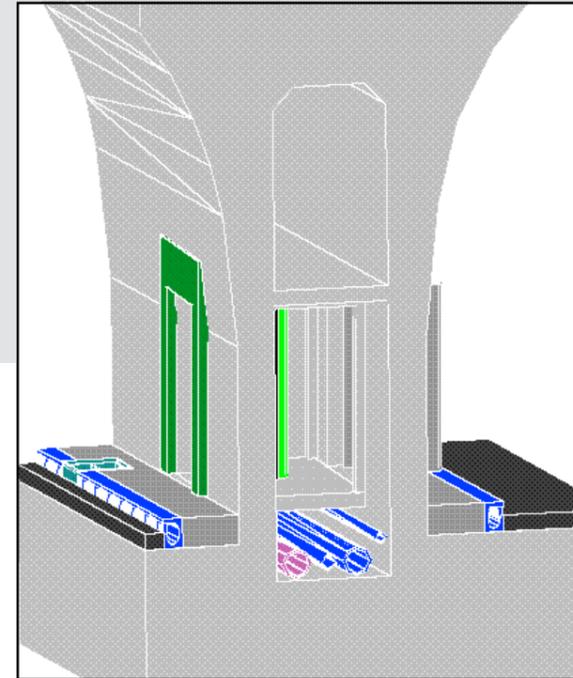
Tunnelentwässerung – Querschnitt im Bereich Betriebsgang mit Fluchtschleuse
